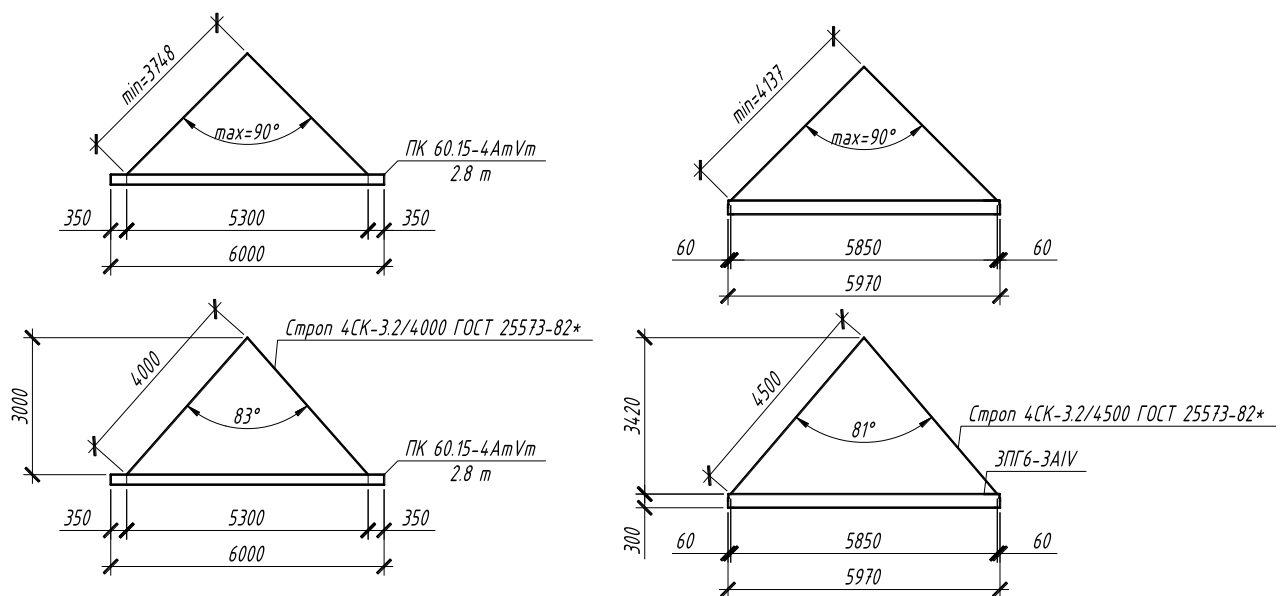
Схемы к выбору стропов для монтажа плит
